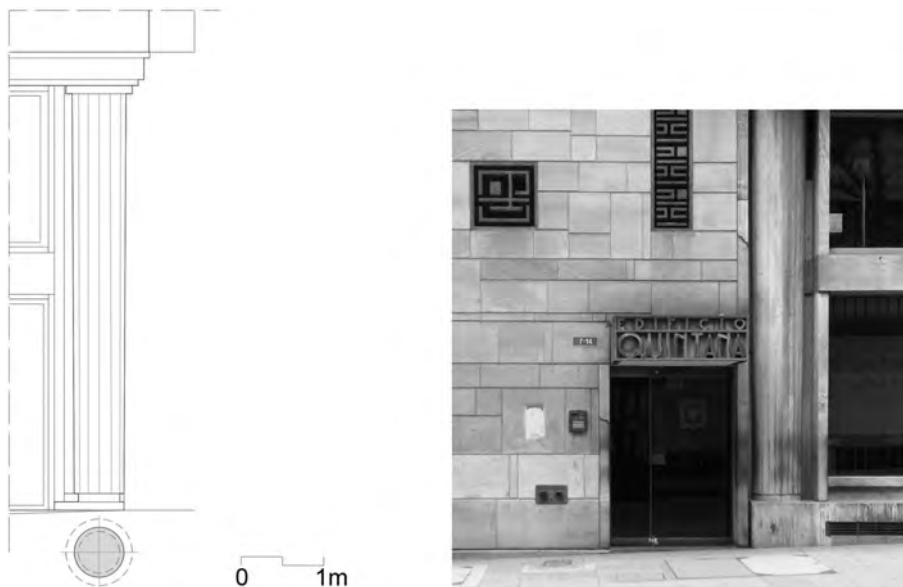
Da sinistra verso destra. Quintana, dettaglio della colonna d'angolo. Fonte: elaborazione dell'autrice. Quintana, porzione del prospetto sulla *Cl. 12*. Fonte: foto dell'autrice, 2017.
